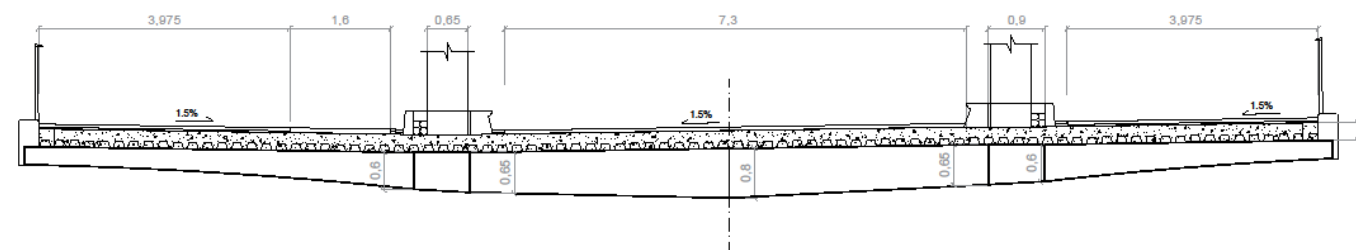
Propuesta A - Sección transversal del tablero. Elaboración propia con AutoCAD.
